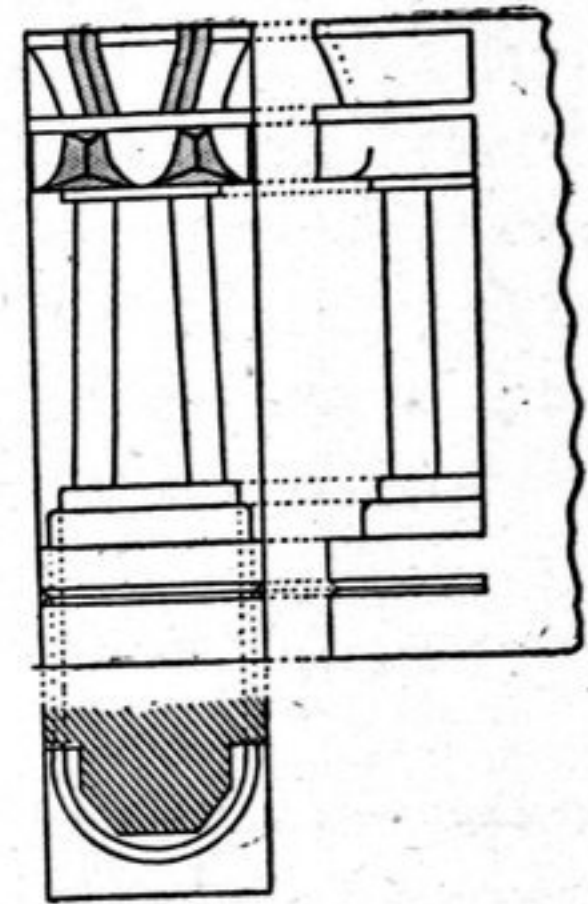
Pierre de taille d'un pilastre, TK, 13.
